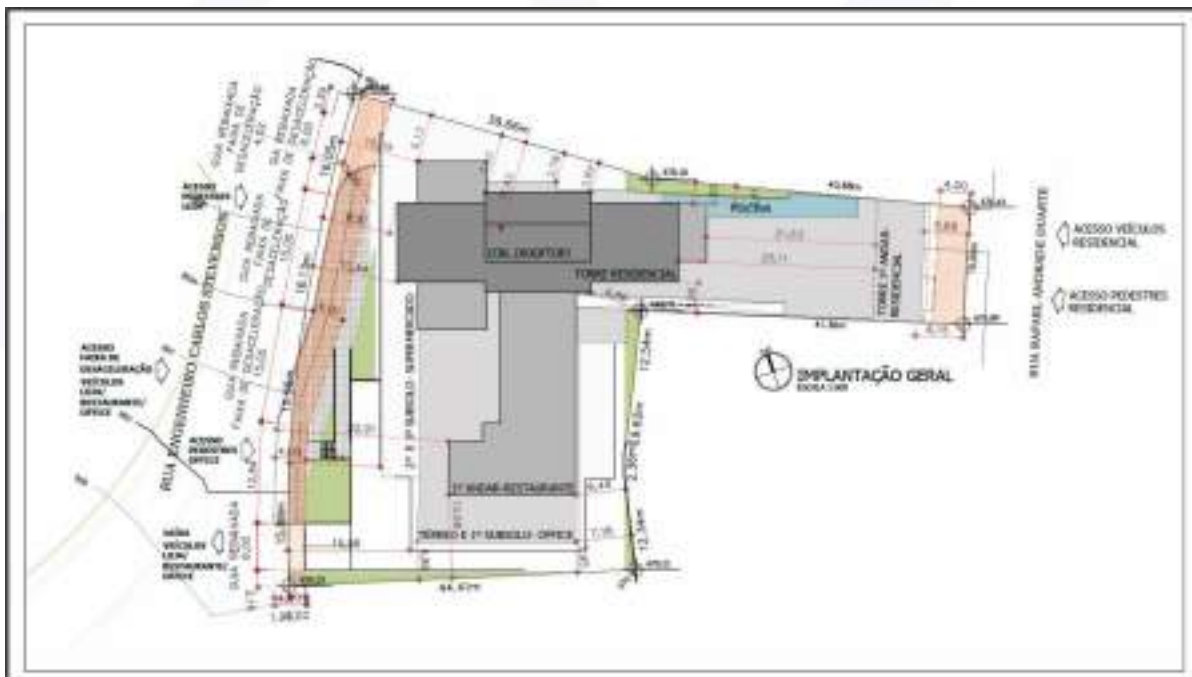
Projeto Urbanístico Simplificado – Planta baixa
